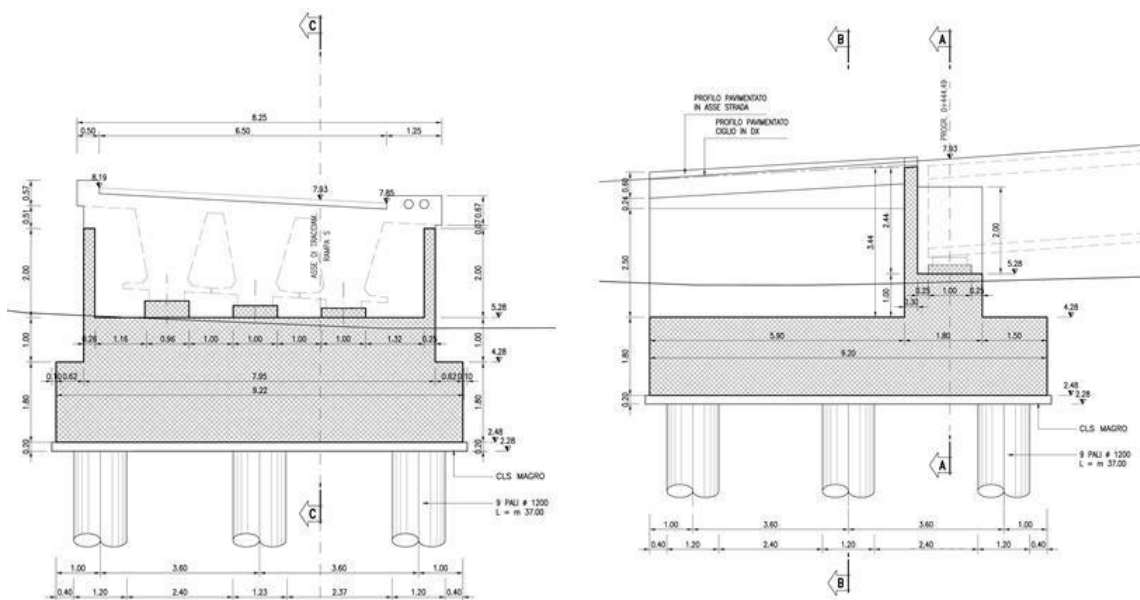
prospetto e sezione longitudinale spalla
